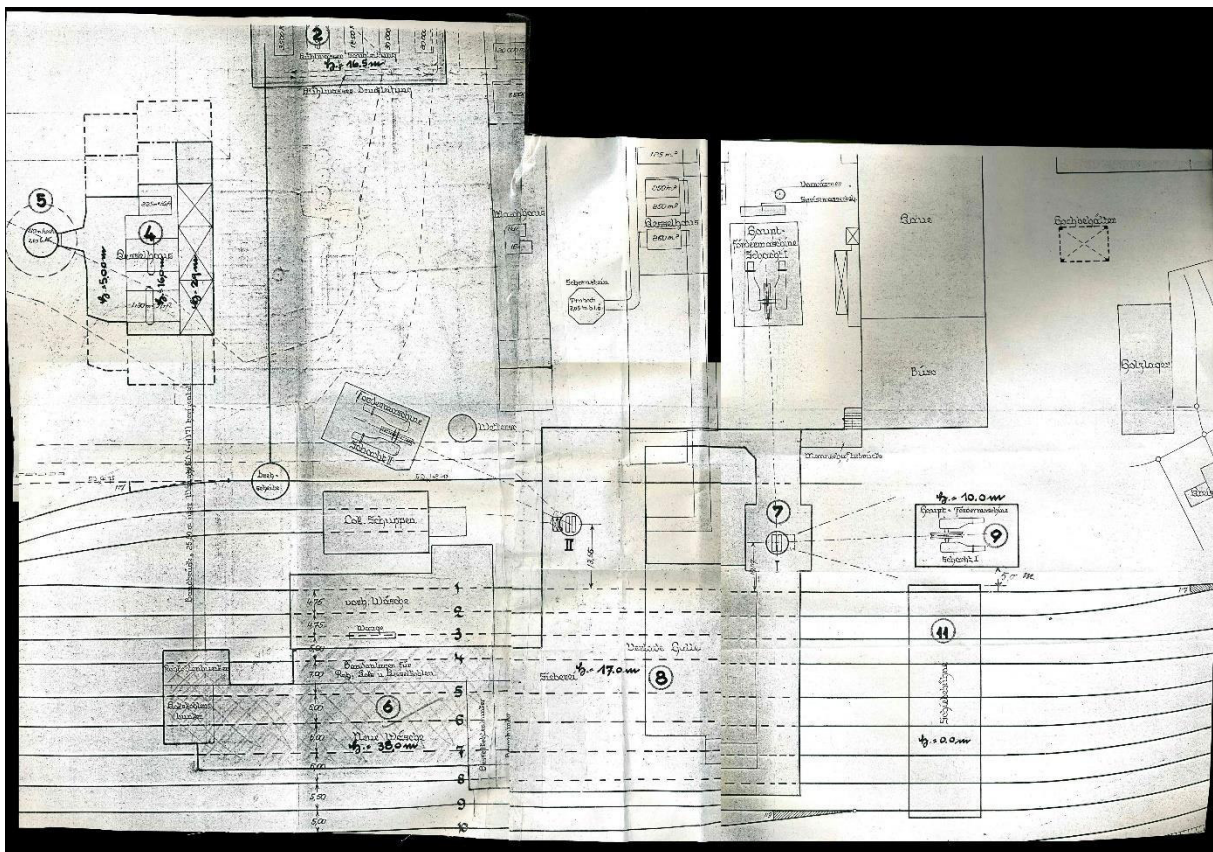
Lageplan, Schacht Fritz - Heinrich
